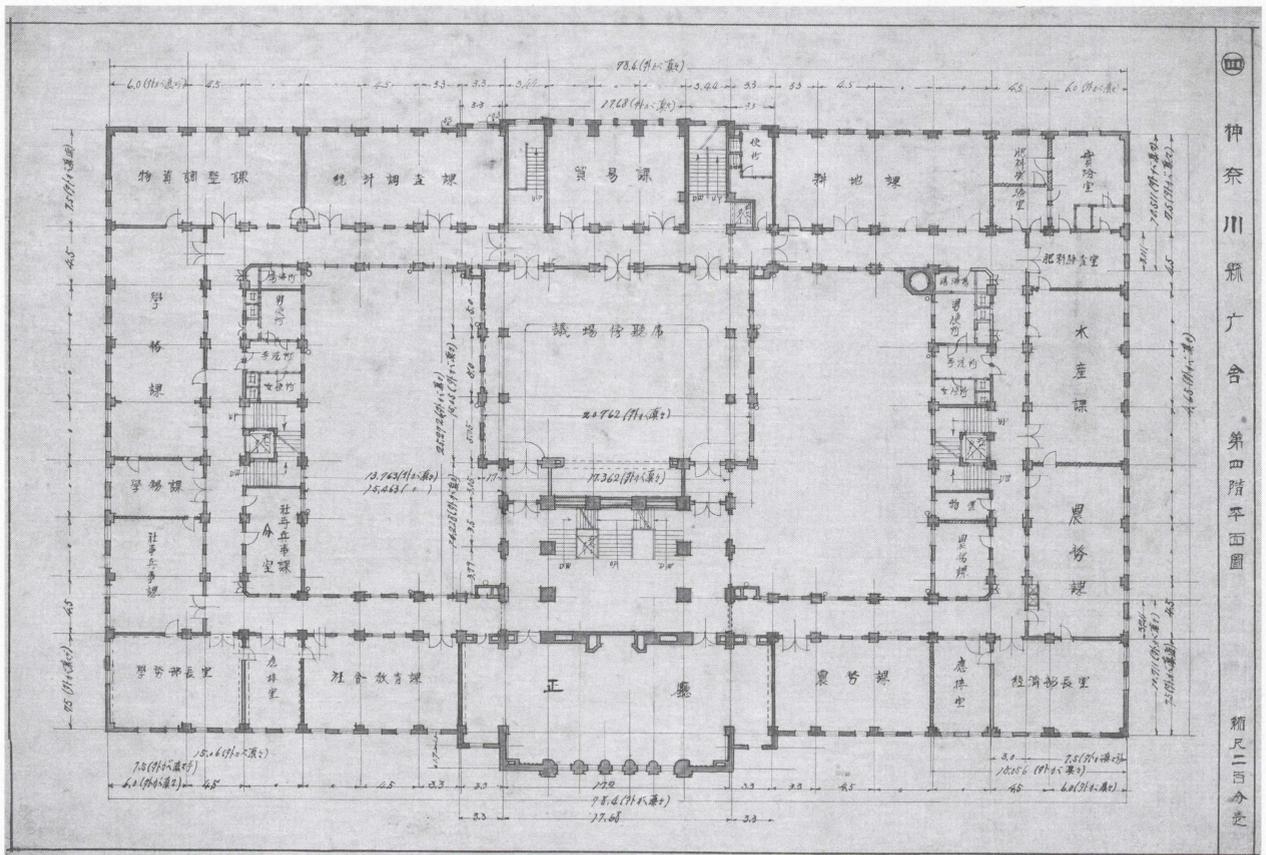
神奈川県庁舎 第四階平面图 縮尺二百分卷 (目錄No.161)
